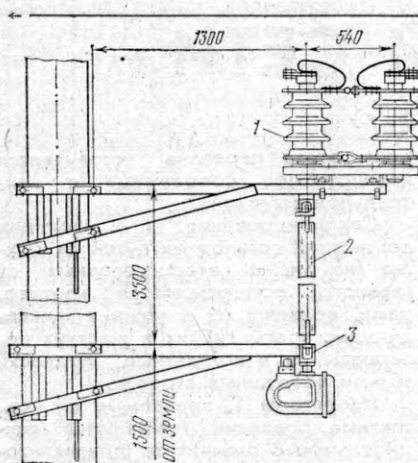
Секционный разъединитель переменного тока с моторным приводом:
